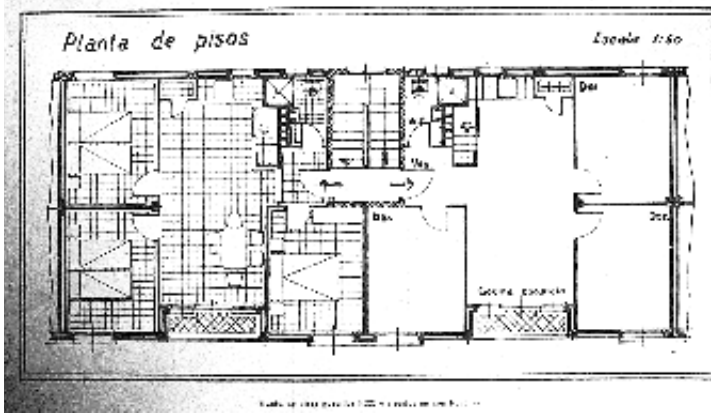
Planta de una vivienda de iniciativa estatal. Pág. 10
